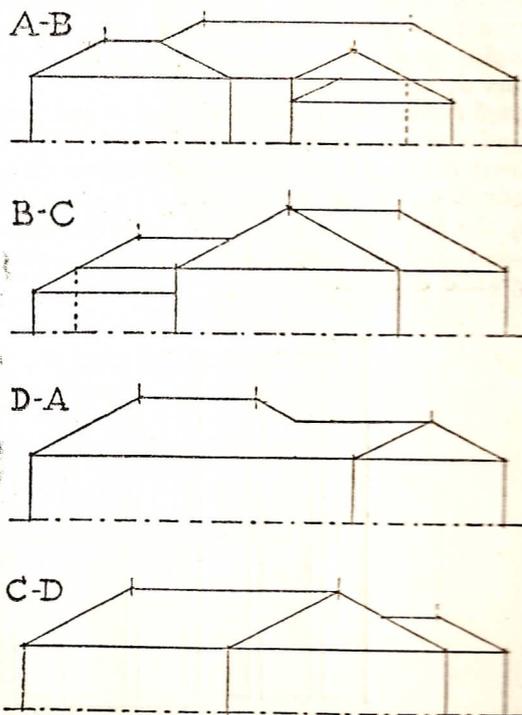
ALÇADOS DE UM TELhado MOVIMENTADO
